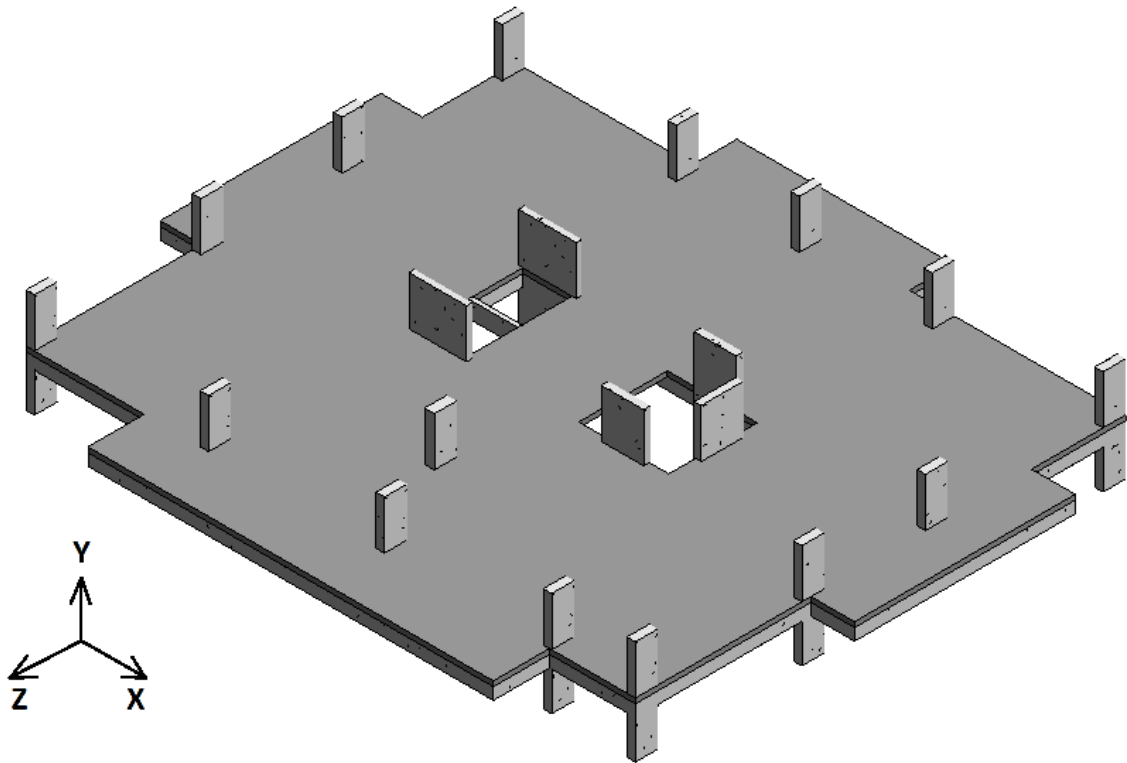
Perspectiva pavimento tipo - Modelos A e B
